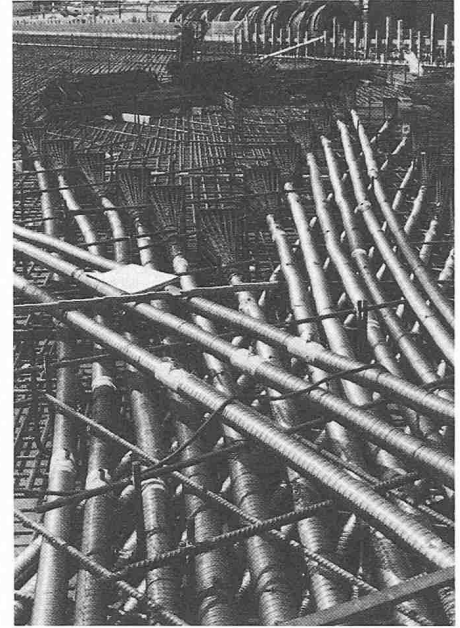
Im Plattenbereich abgespannte Kabel (ohne schlaaffe Verankerungsbewehrung)
